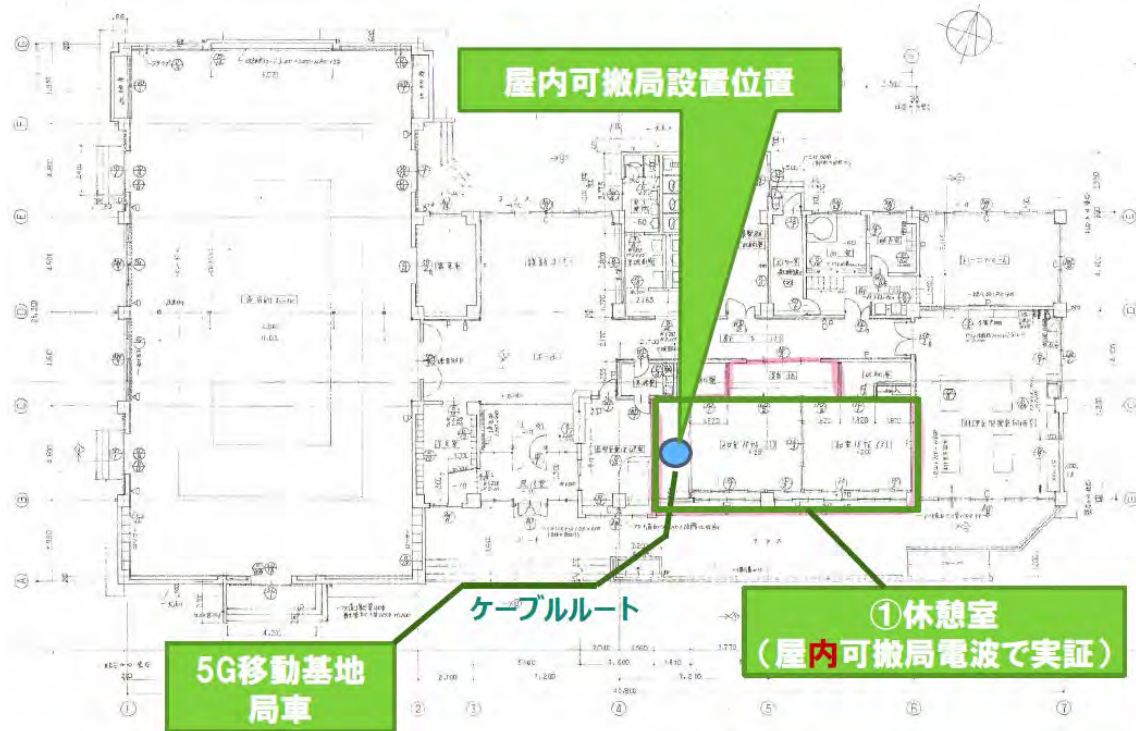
建物平面図からみた実証会場と屋内設置の可搬局の位置
